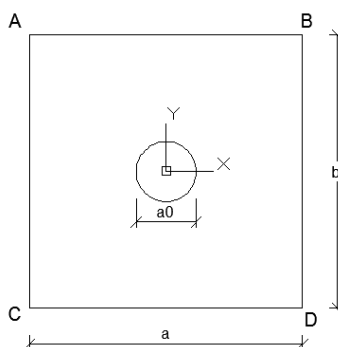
Vista em Planta da Sapata e Implantação do Pilar
